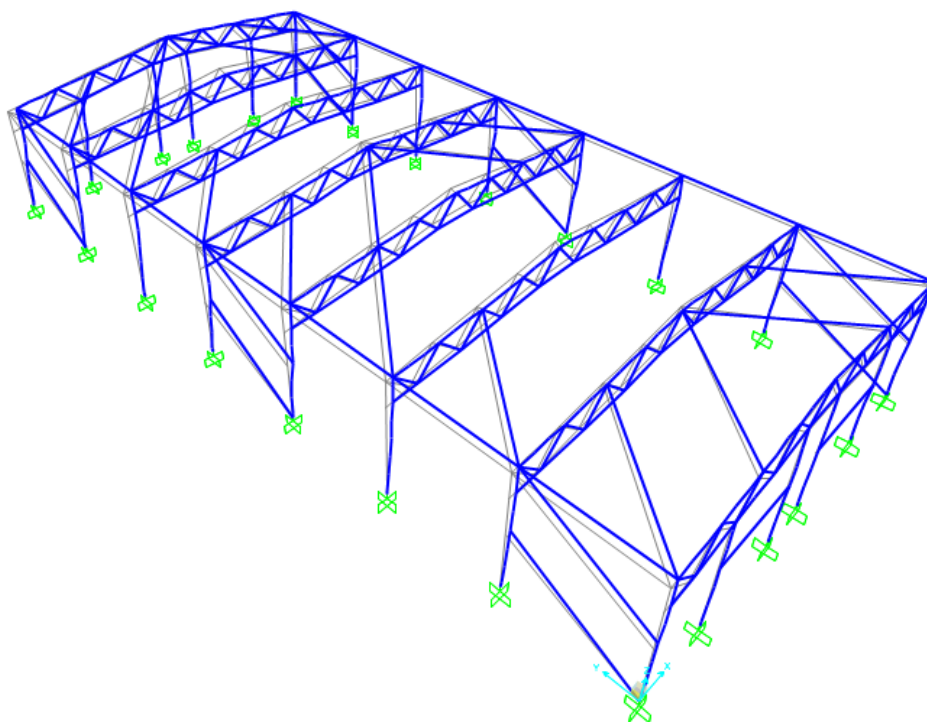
Deformada nave con pórticos cada 12 m, ELS5, con arriostramientos transversales y longitudinales
